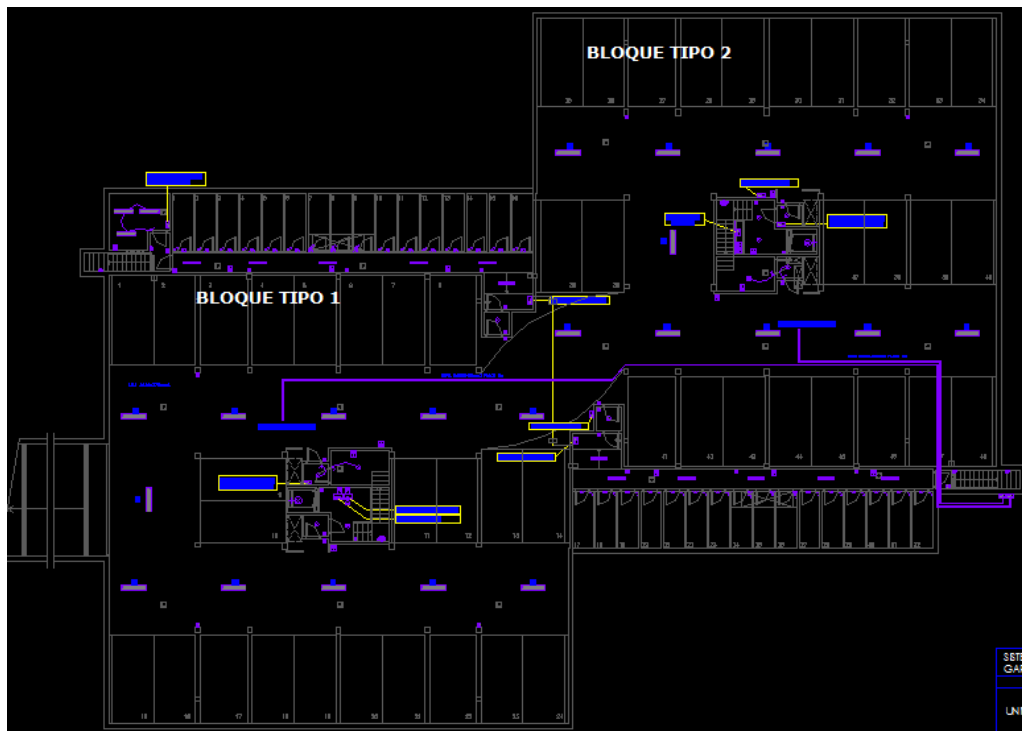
Detalle del plano E1-09, instalaciones eléctricas del edificio tipo.
